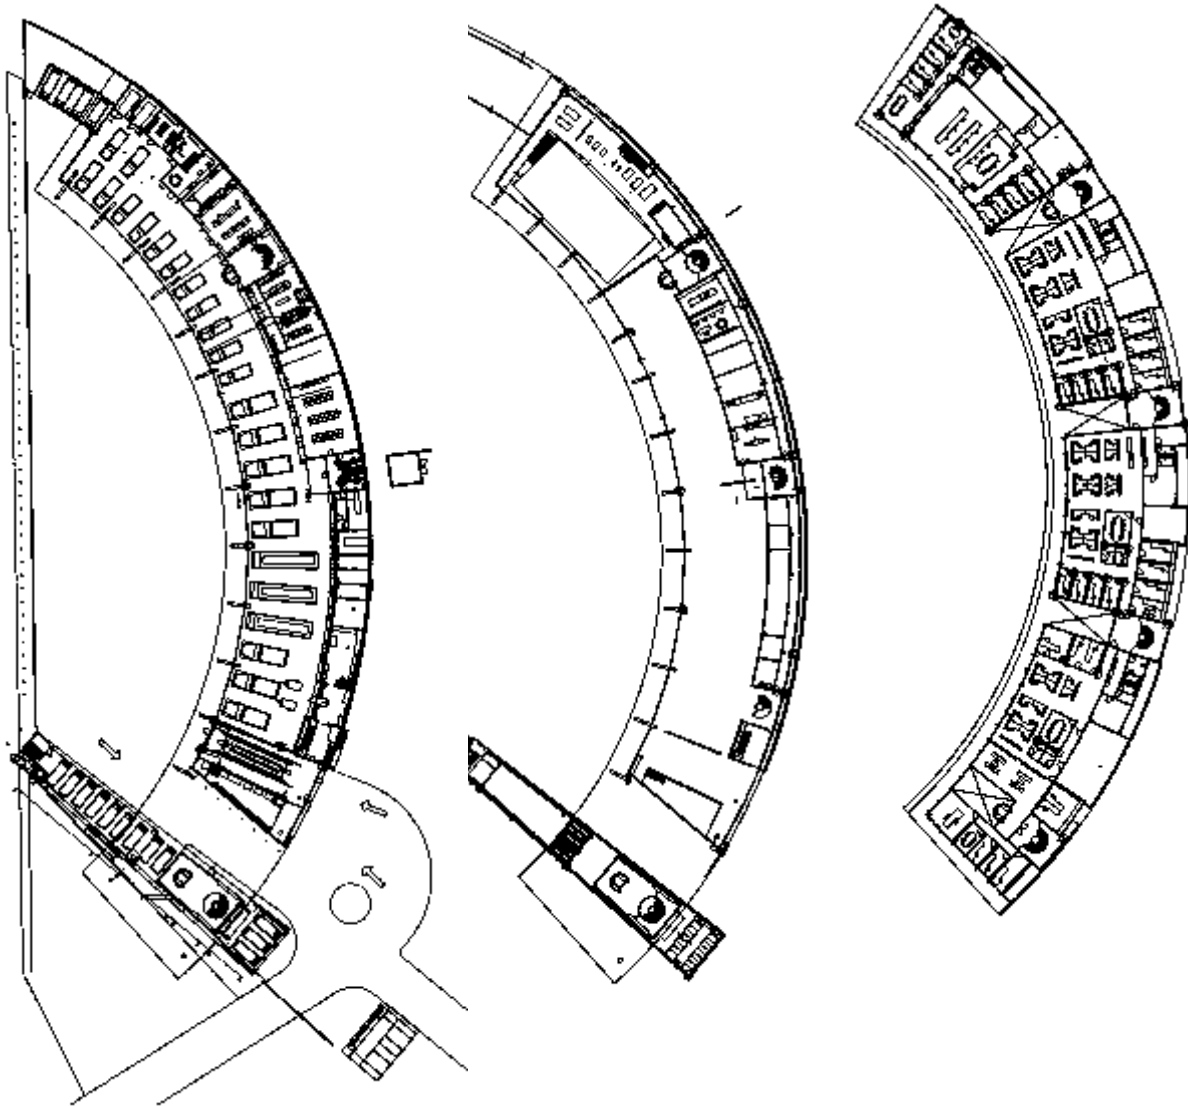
/ planta baja, segunda y tercer planta Estación de bomberos Stein Halvorsen Sivilarkitekter/
